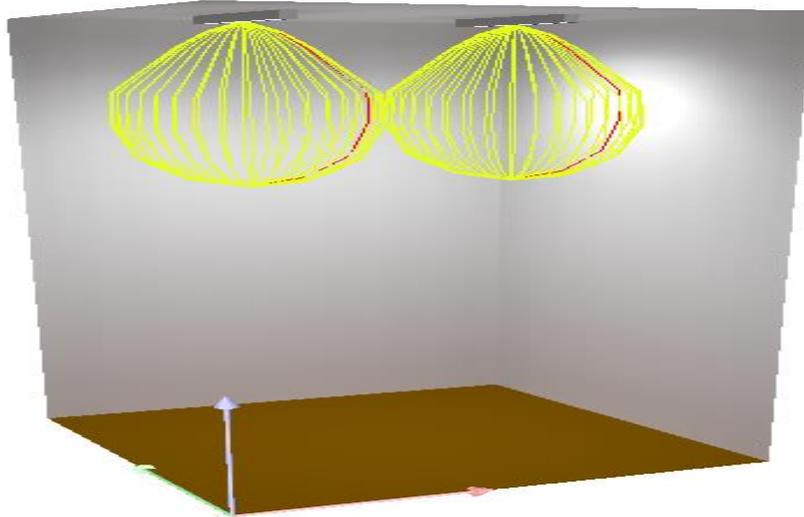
Sebaran Cahaya pada Ruang UIK / Ruang Kerja
